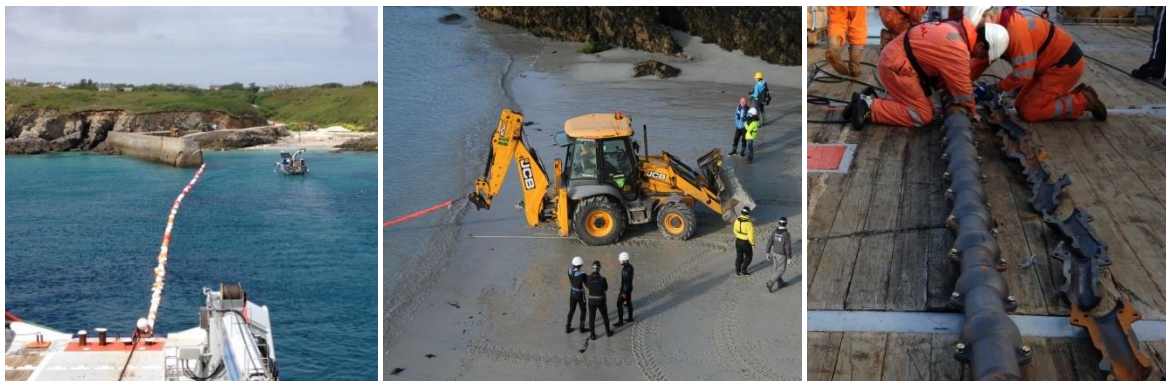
Positionnement de l'Argonaute – traction du câble sur la plage – mise en place des coquilles (SABELLA SA)
